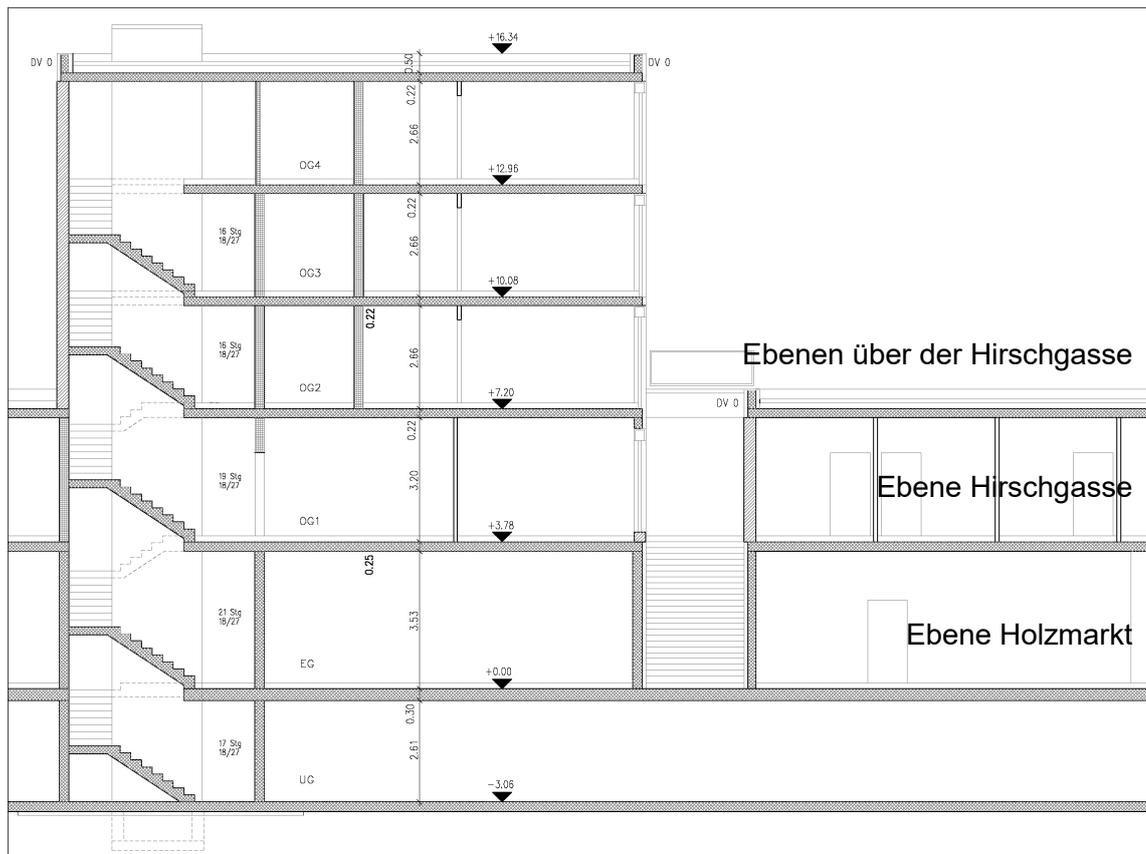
Längsschnitt durch das Gebäude (Haus B) und die Sockelgeschosse
